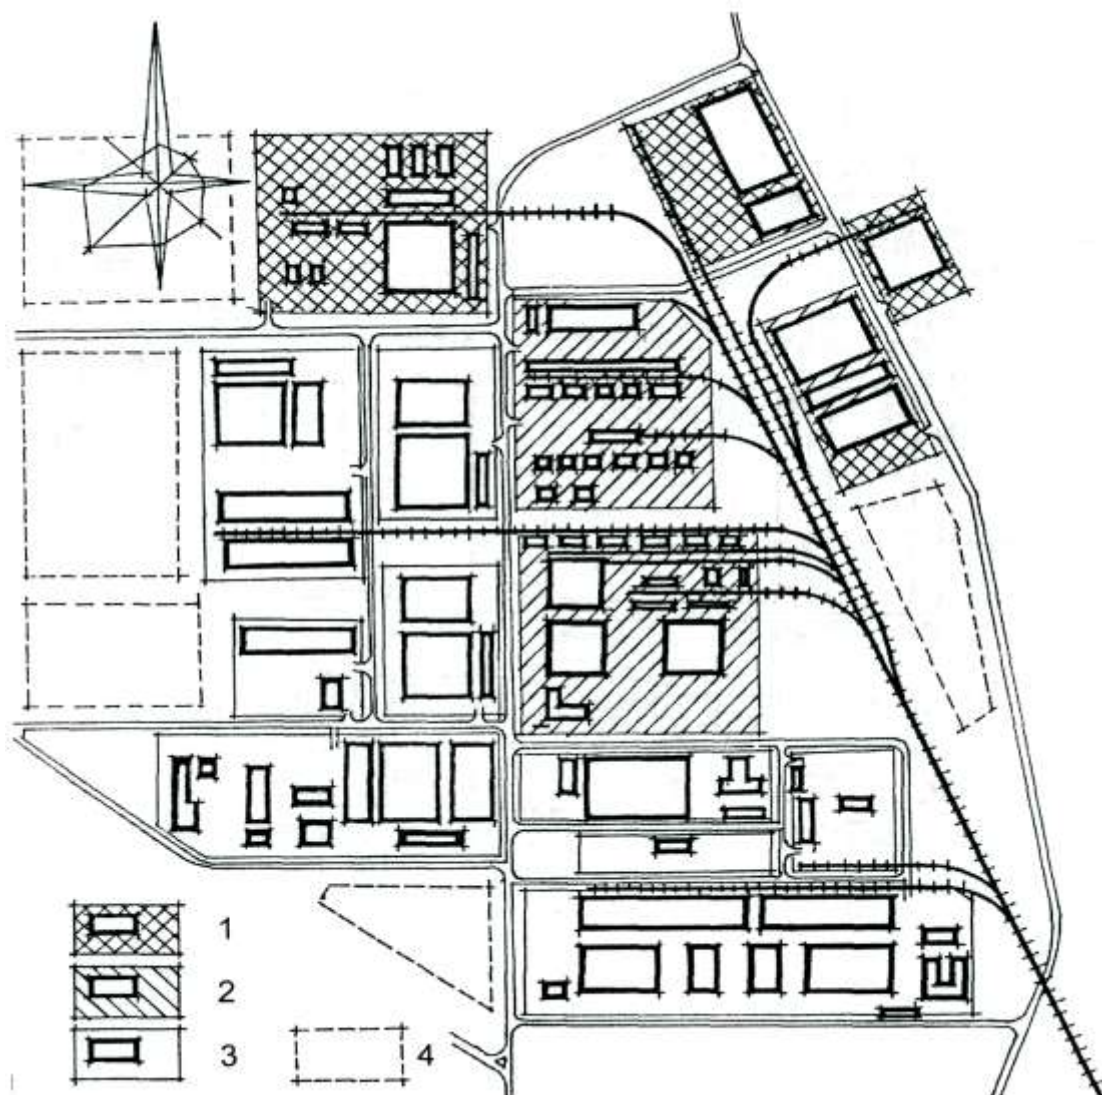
Промисловий вузол. Схема генерального плану:
